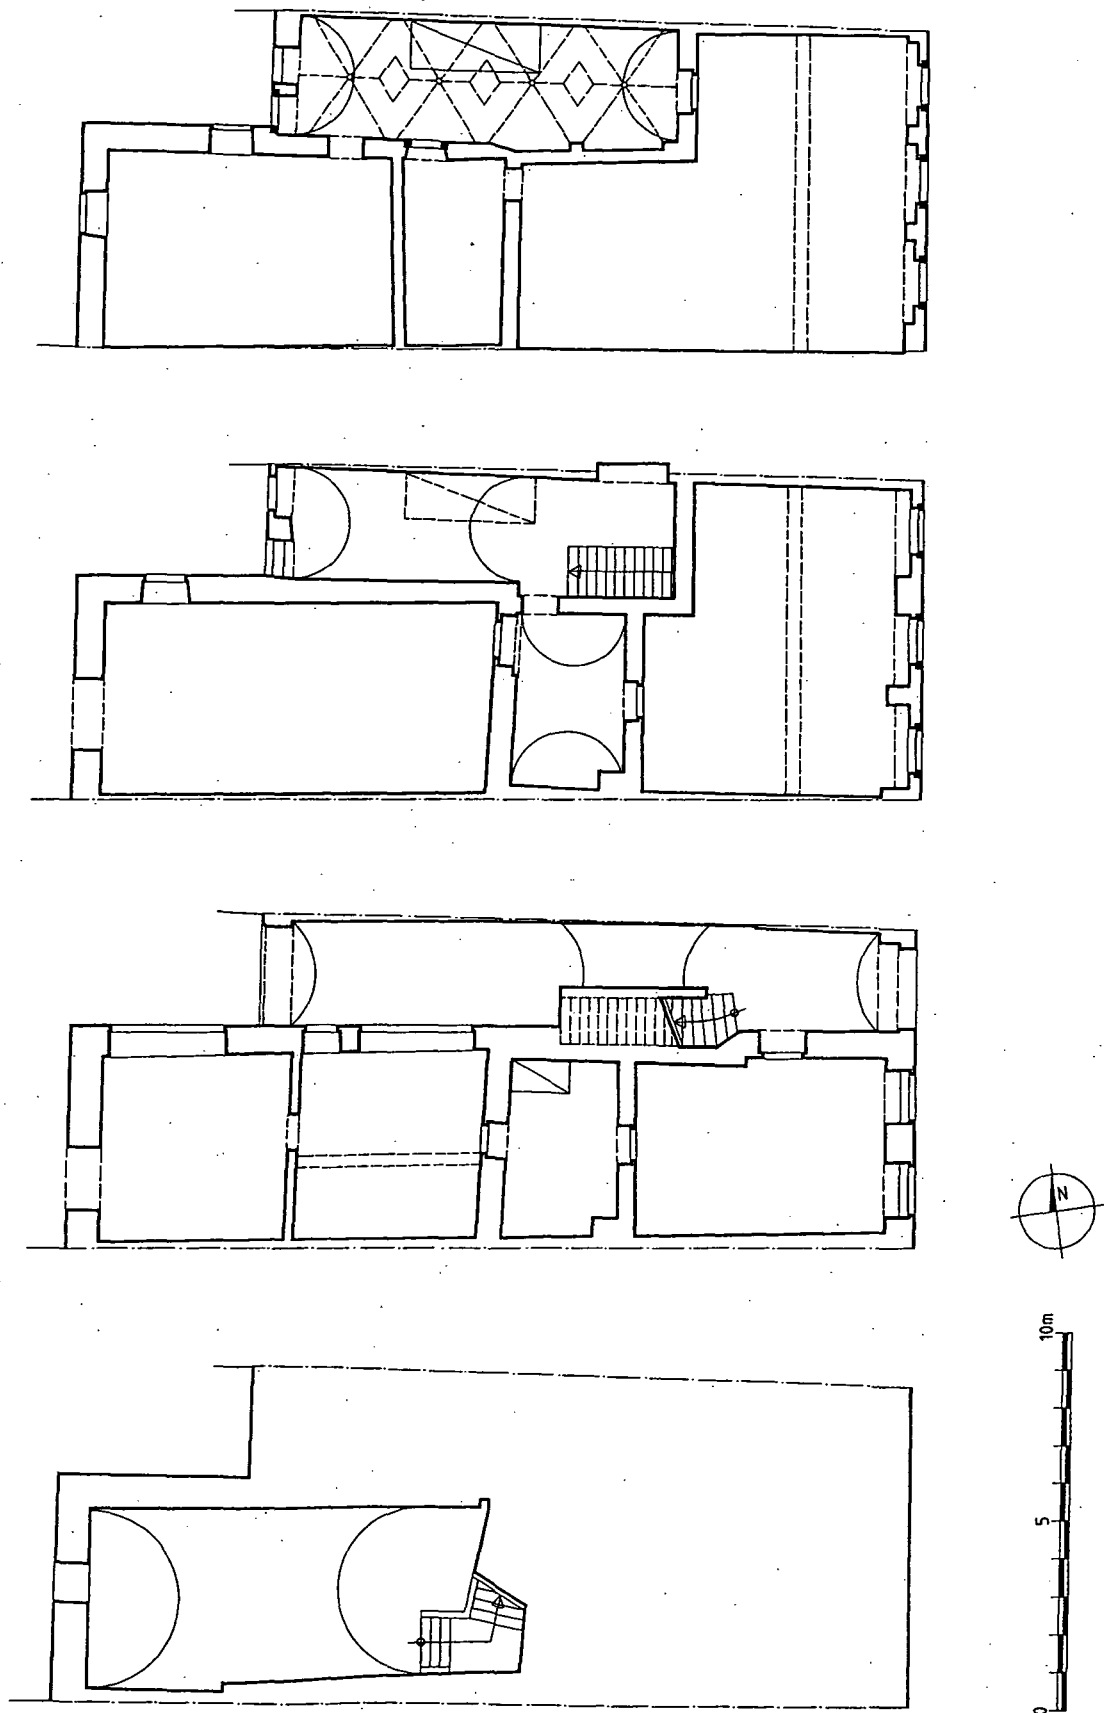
Stadtplatz 26 – Grundrisse Keller, Erdgeschoss, 1. und 2. Obergeschoss (1:200).
